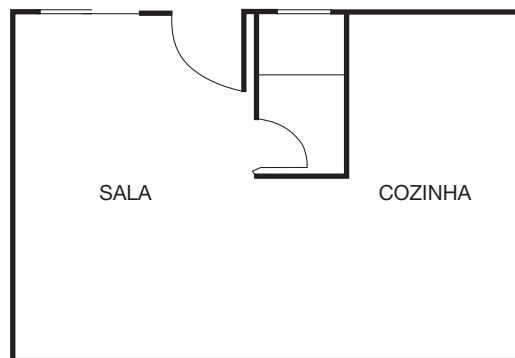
PLANTA DO EMBRIÃO DE 24M2
